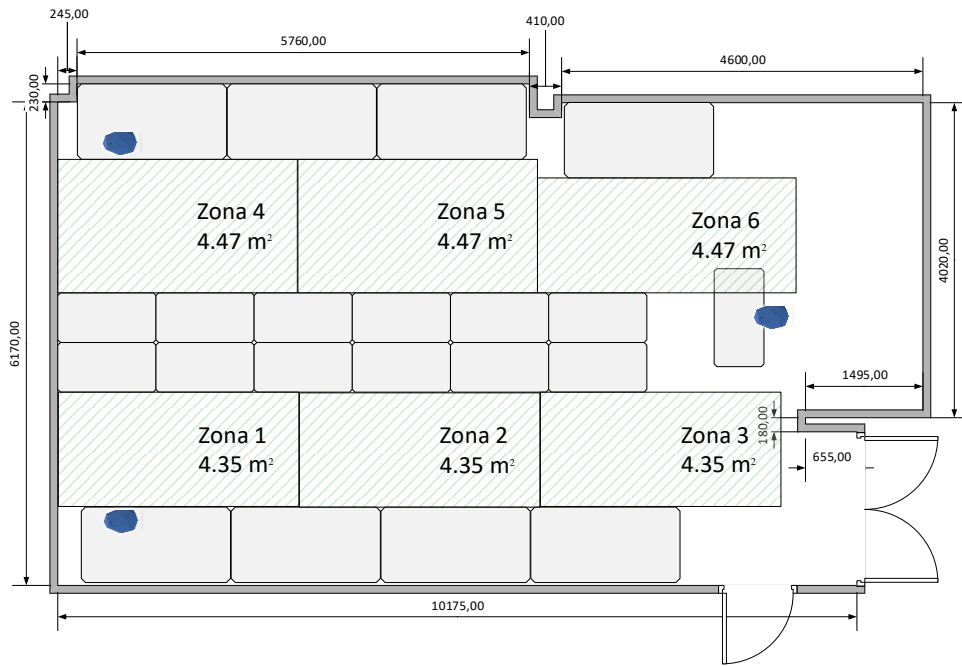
Área de trabajo con 3 beacons, primera ubicación en el techo.
